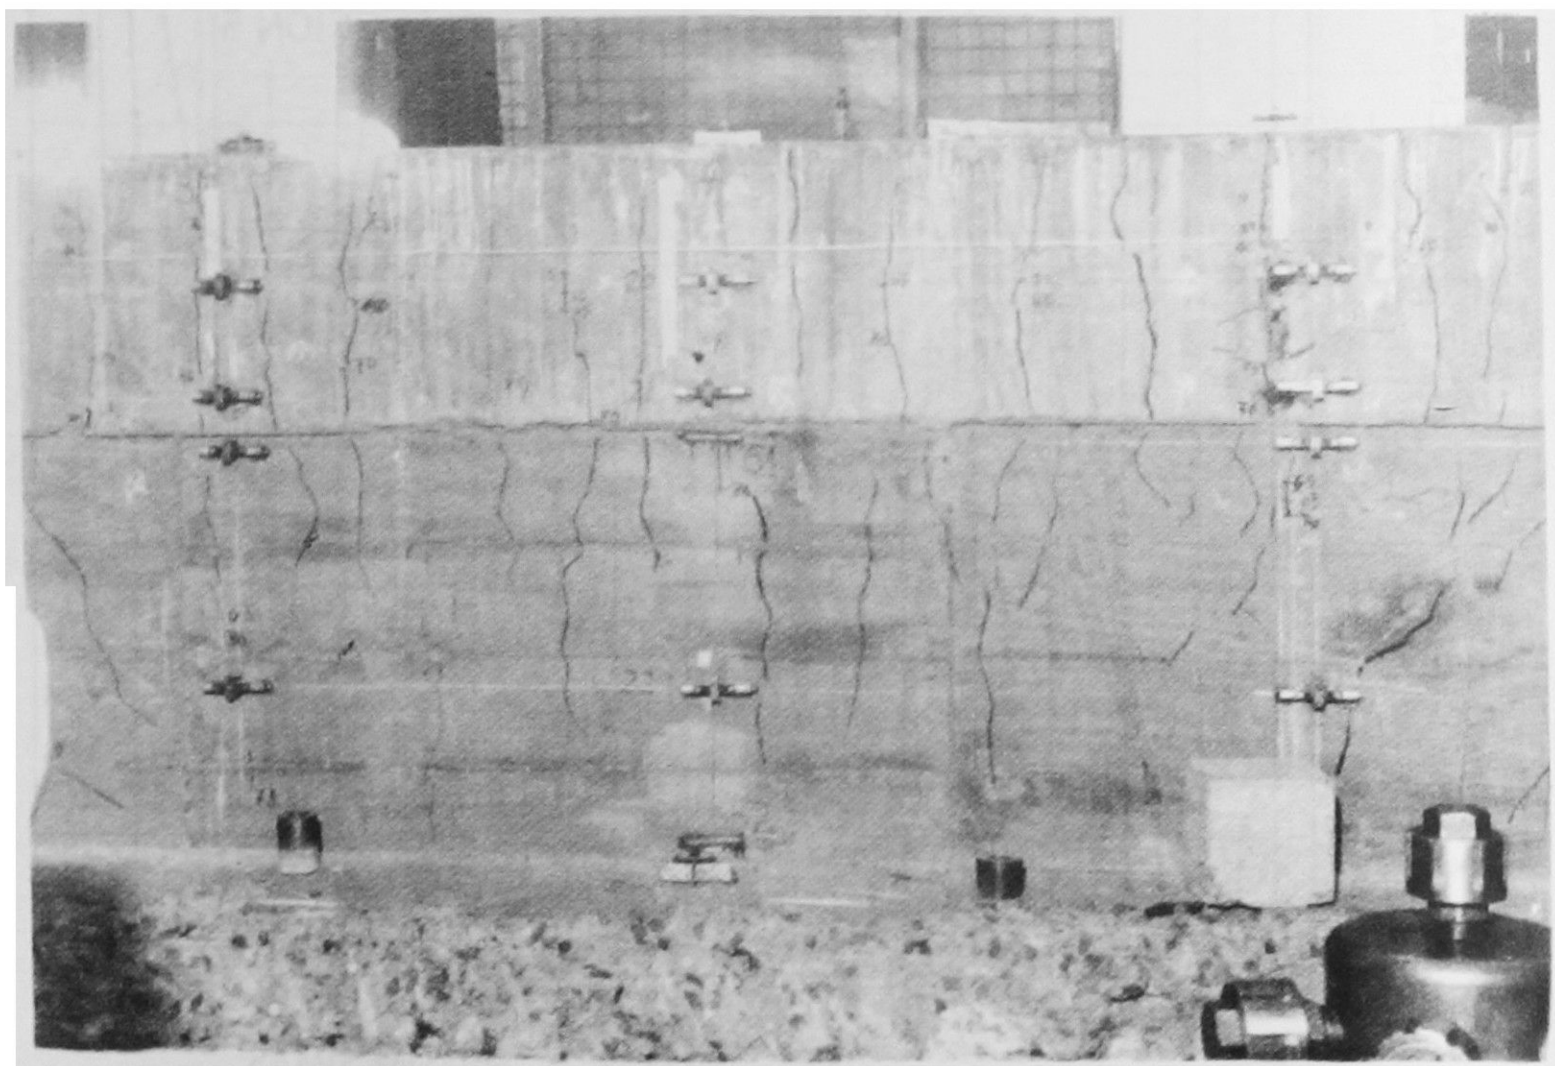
Estado de agrietamiento de la parte central de la viga después de aplicar 100 toneladas.
